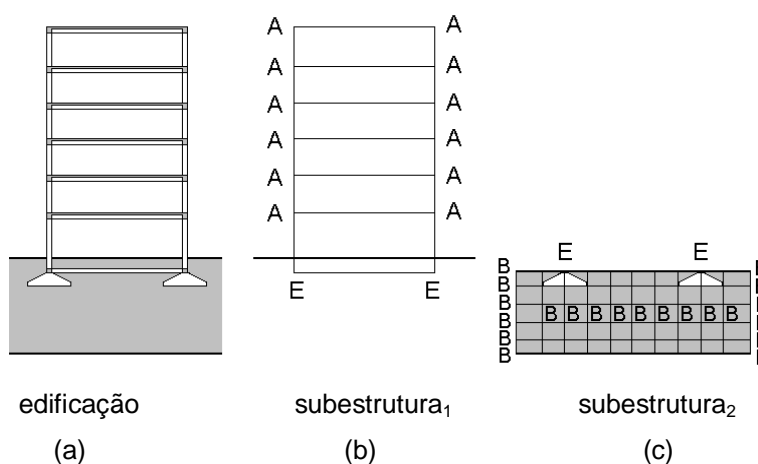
Subestruturação para interação solo-estrutura adotada no Sistema Edifício
